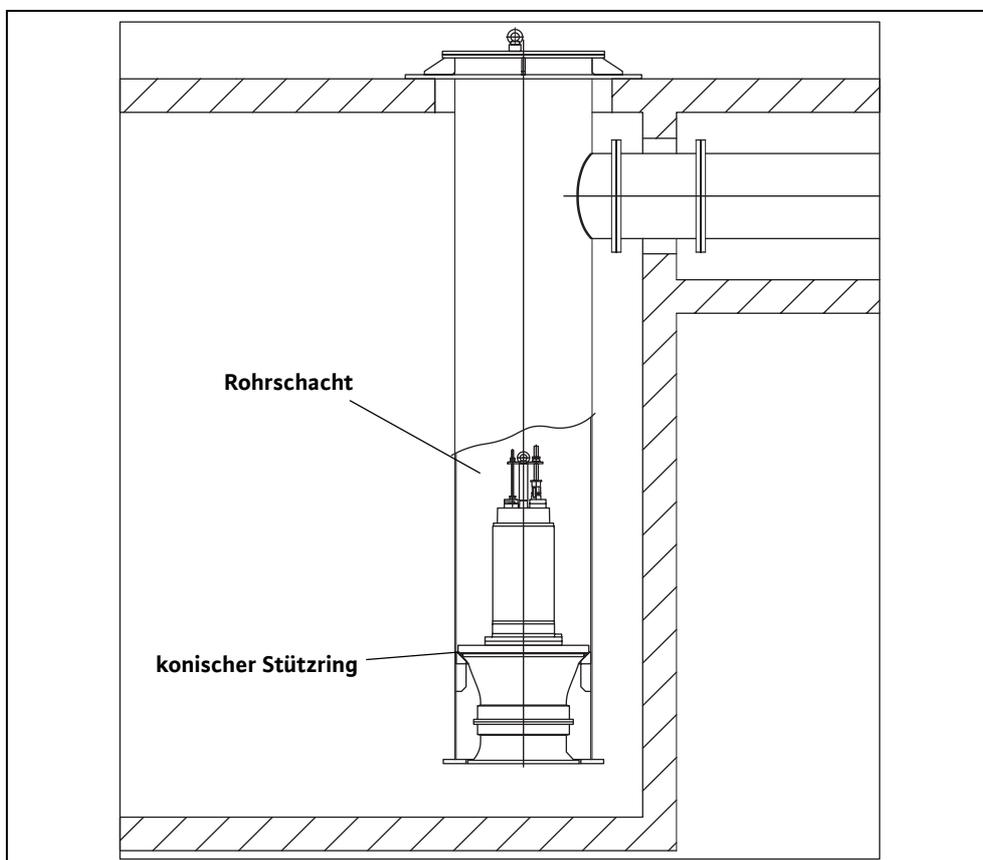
Einbau im Rohr mit Unterflurauflauf
